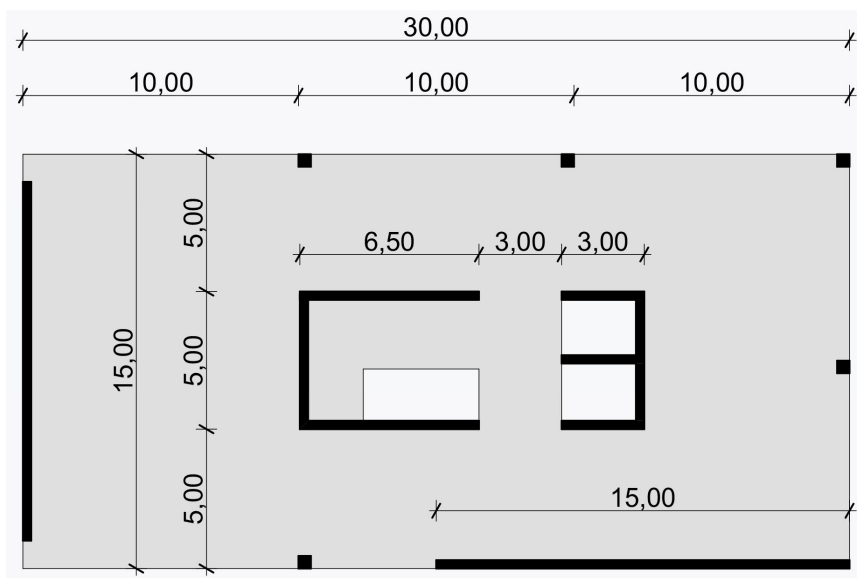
Grundriss des untersuchten Beispielobjektes
